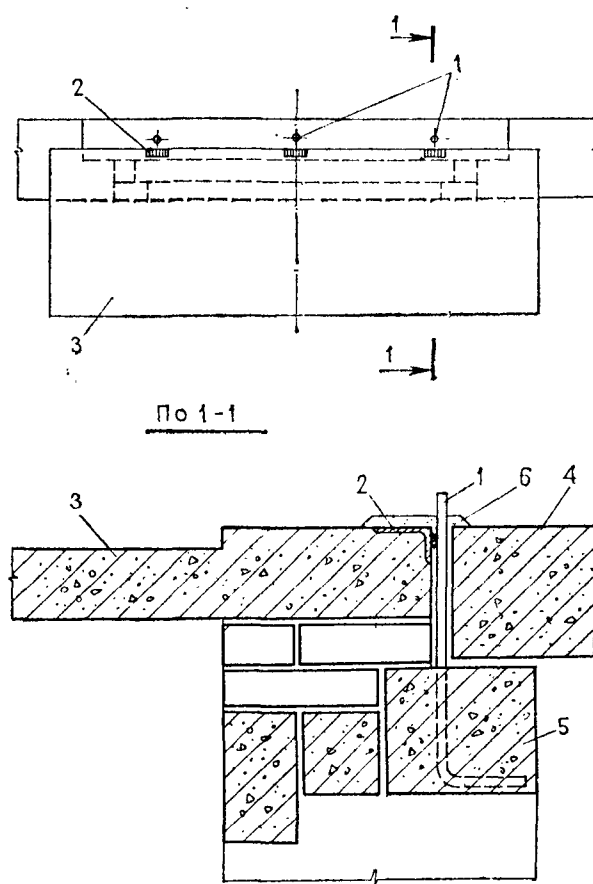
Монтажное крепление балконной плиты в кирпичной стене
